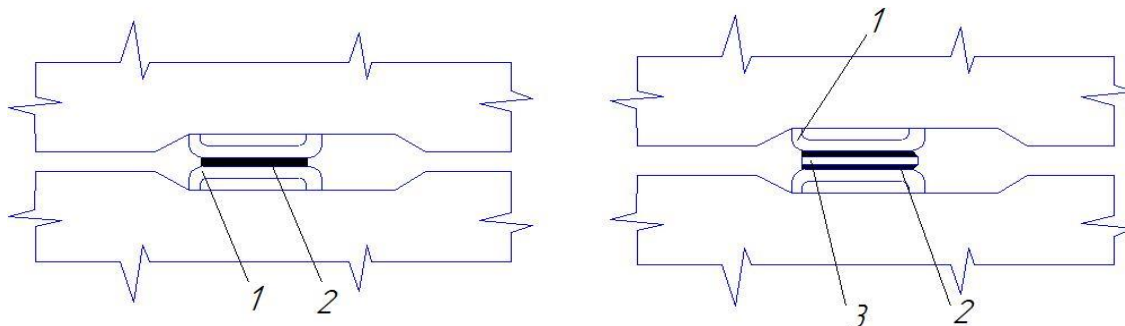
Схема зварювання скоб сусідніх плит:
